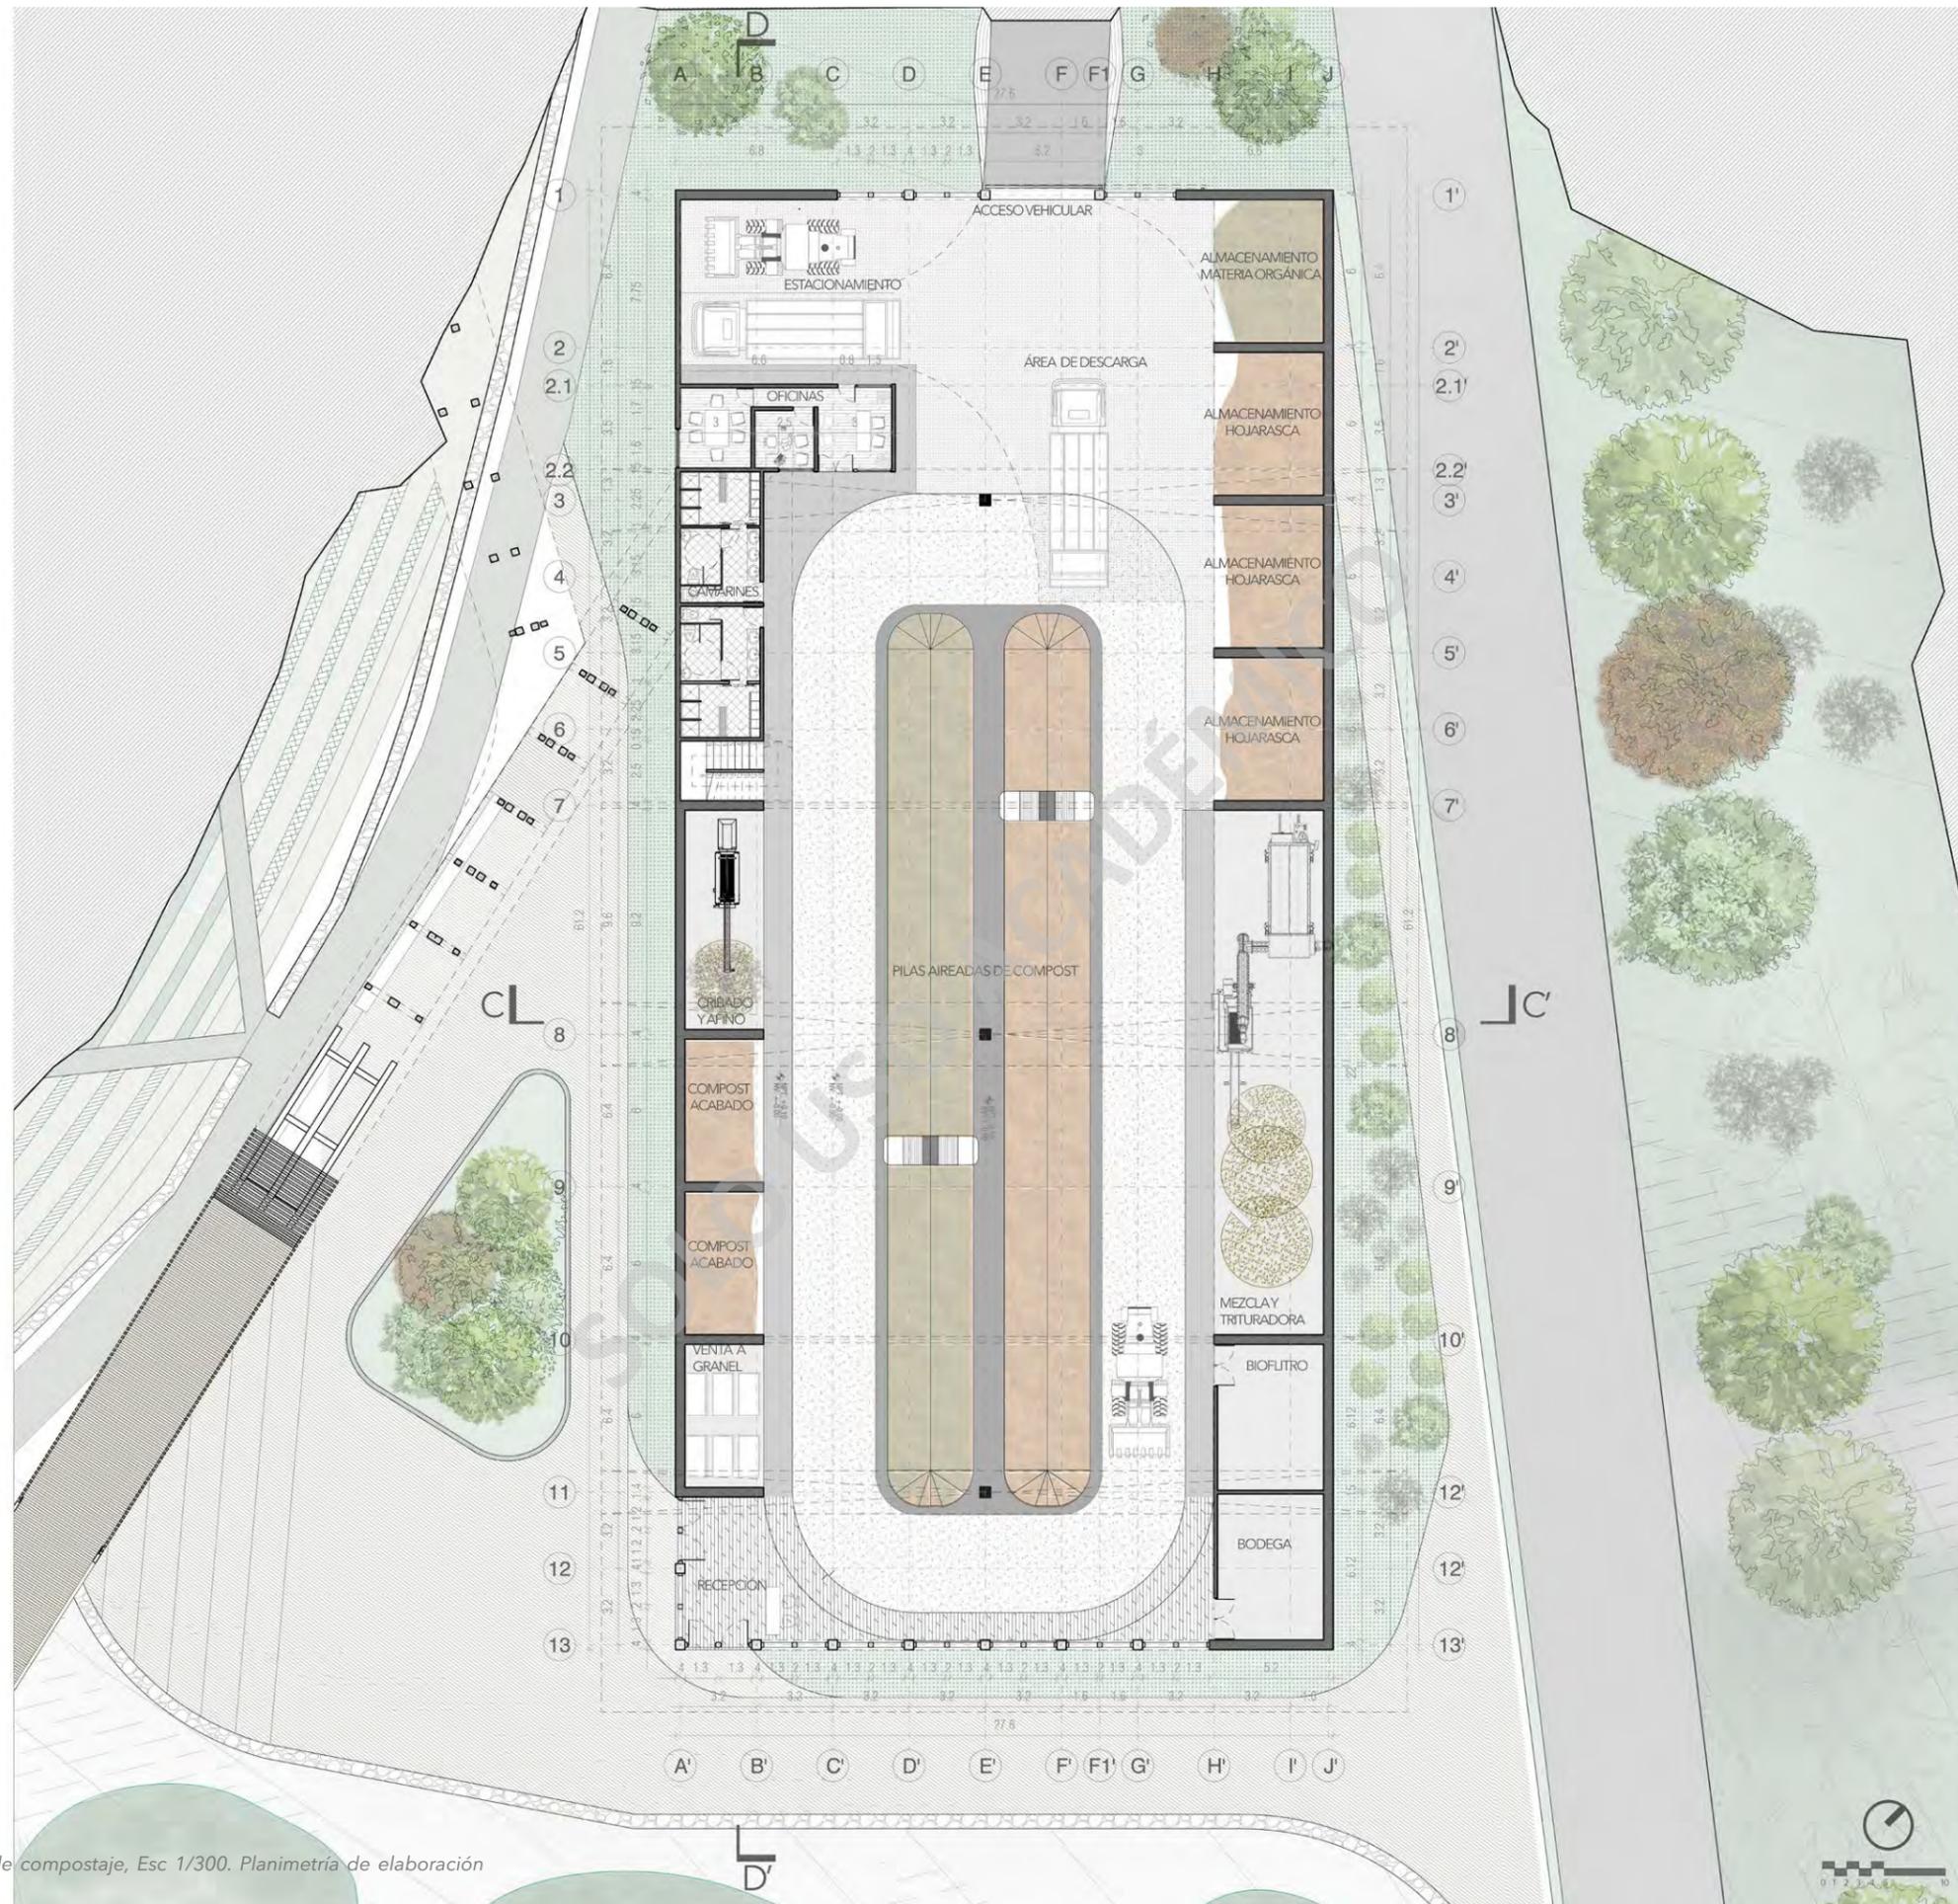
Planta de nivel uno de planta de compostaje, Esc 1/300. Planimetría de elaboración propia.
